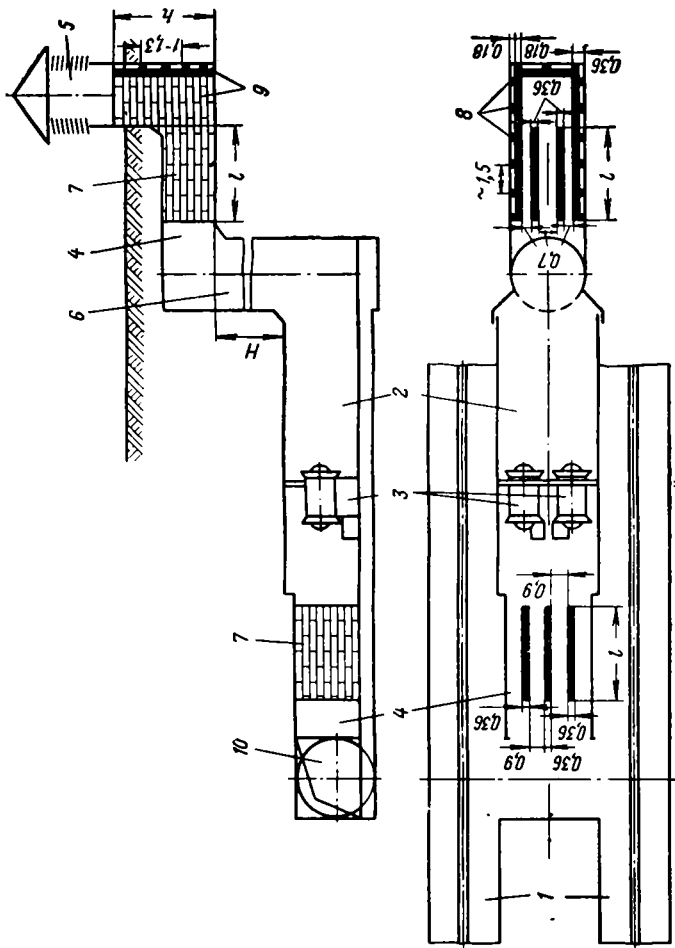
Схема размещения пластинчатых глушителей шума из бетонных шумопоглощающих блоков в вентиляционной установке тоннельной вентиляции, расположенной на перегоне глубокого заложения метрополитена на уровне и между путевыми тоннелями:
